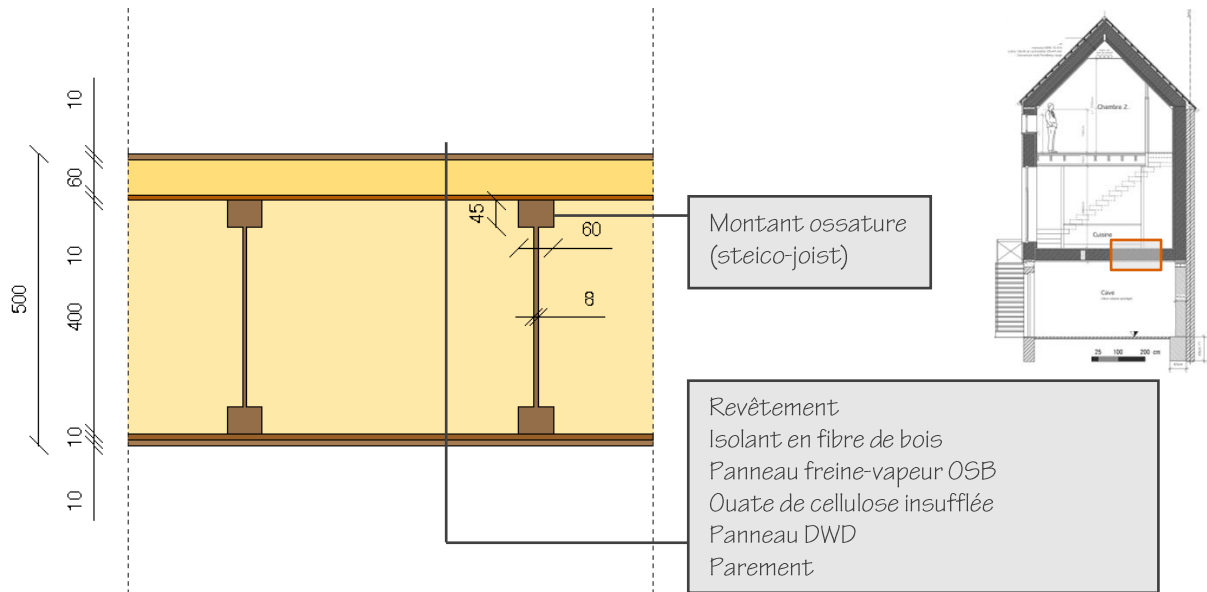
Détail du plancher du 1<sup>er</sup> étage, mesures en [mm]
